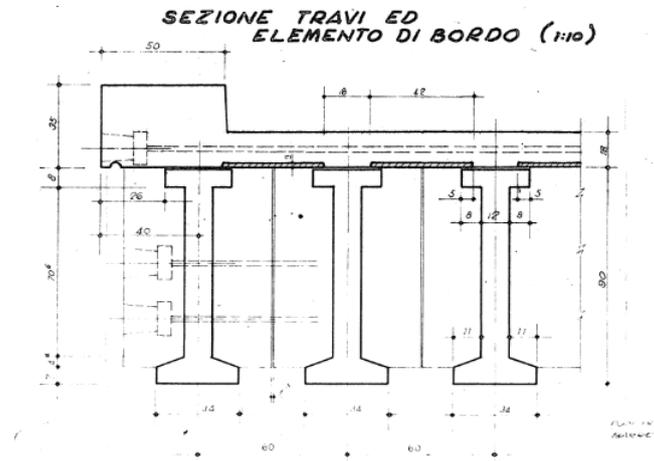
Sezione trasversale impalcato con elemento di bordo.
